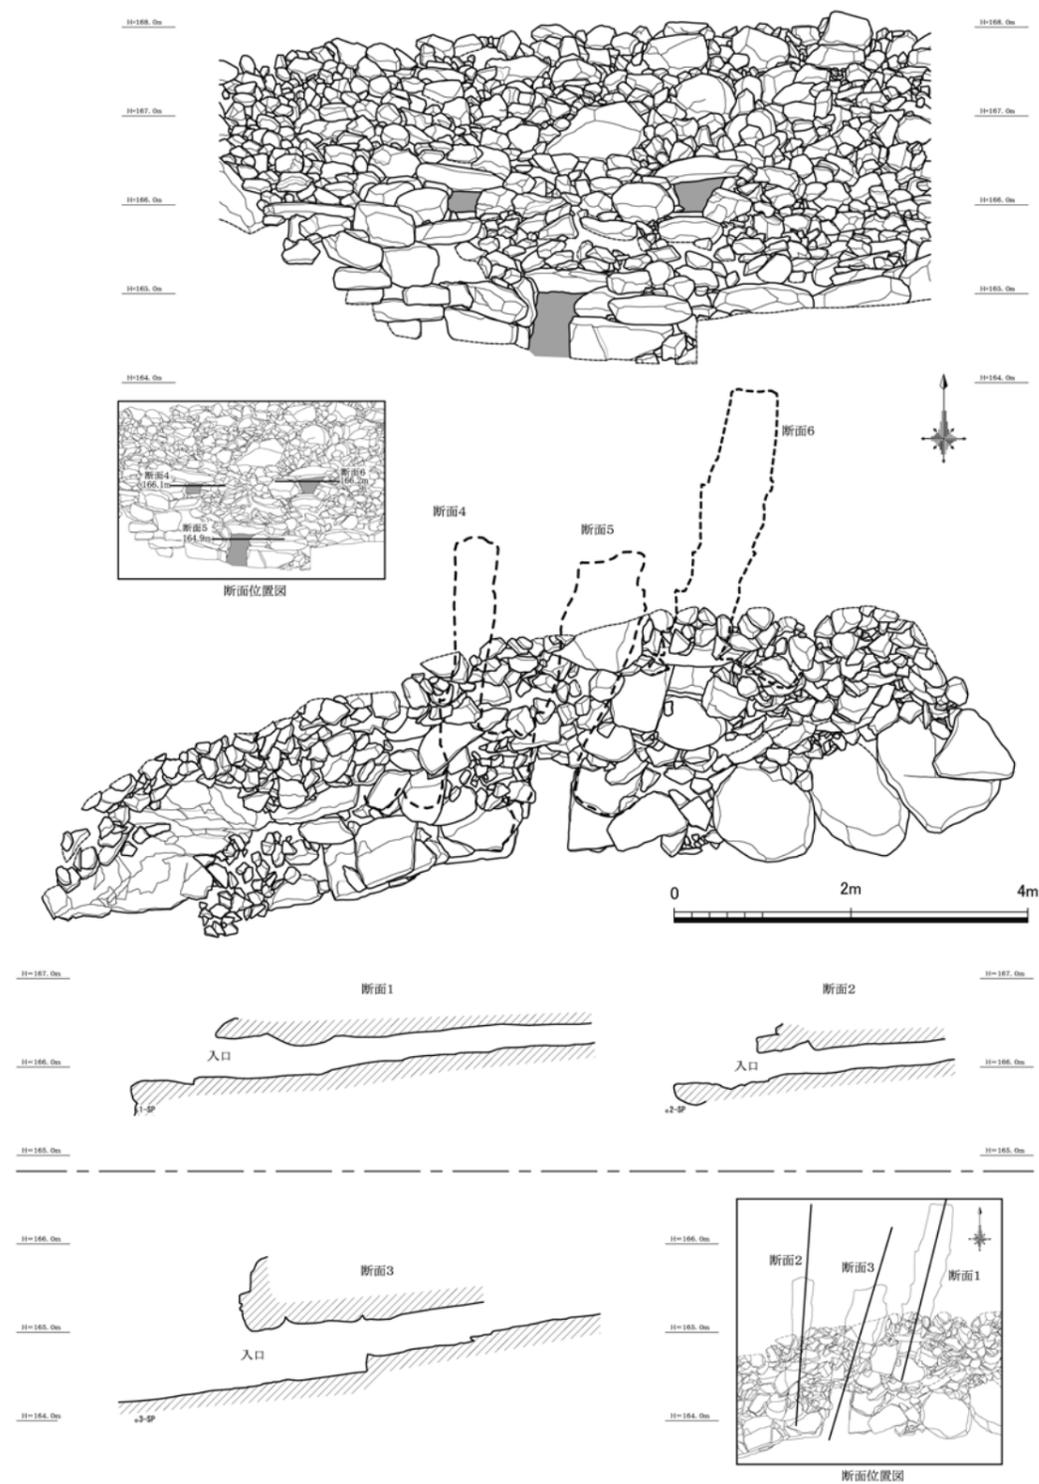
基肄城跡の通水溝1～3 立面図・平面図・縦断面(1/80)
